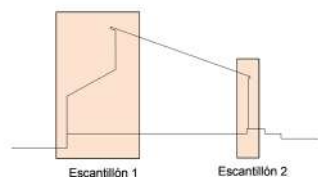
Escantillón de invernadero y muro de la fachada norte en el refugio para montañistas
